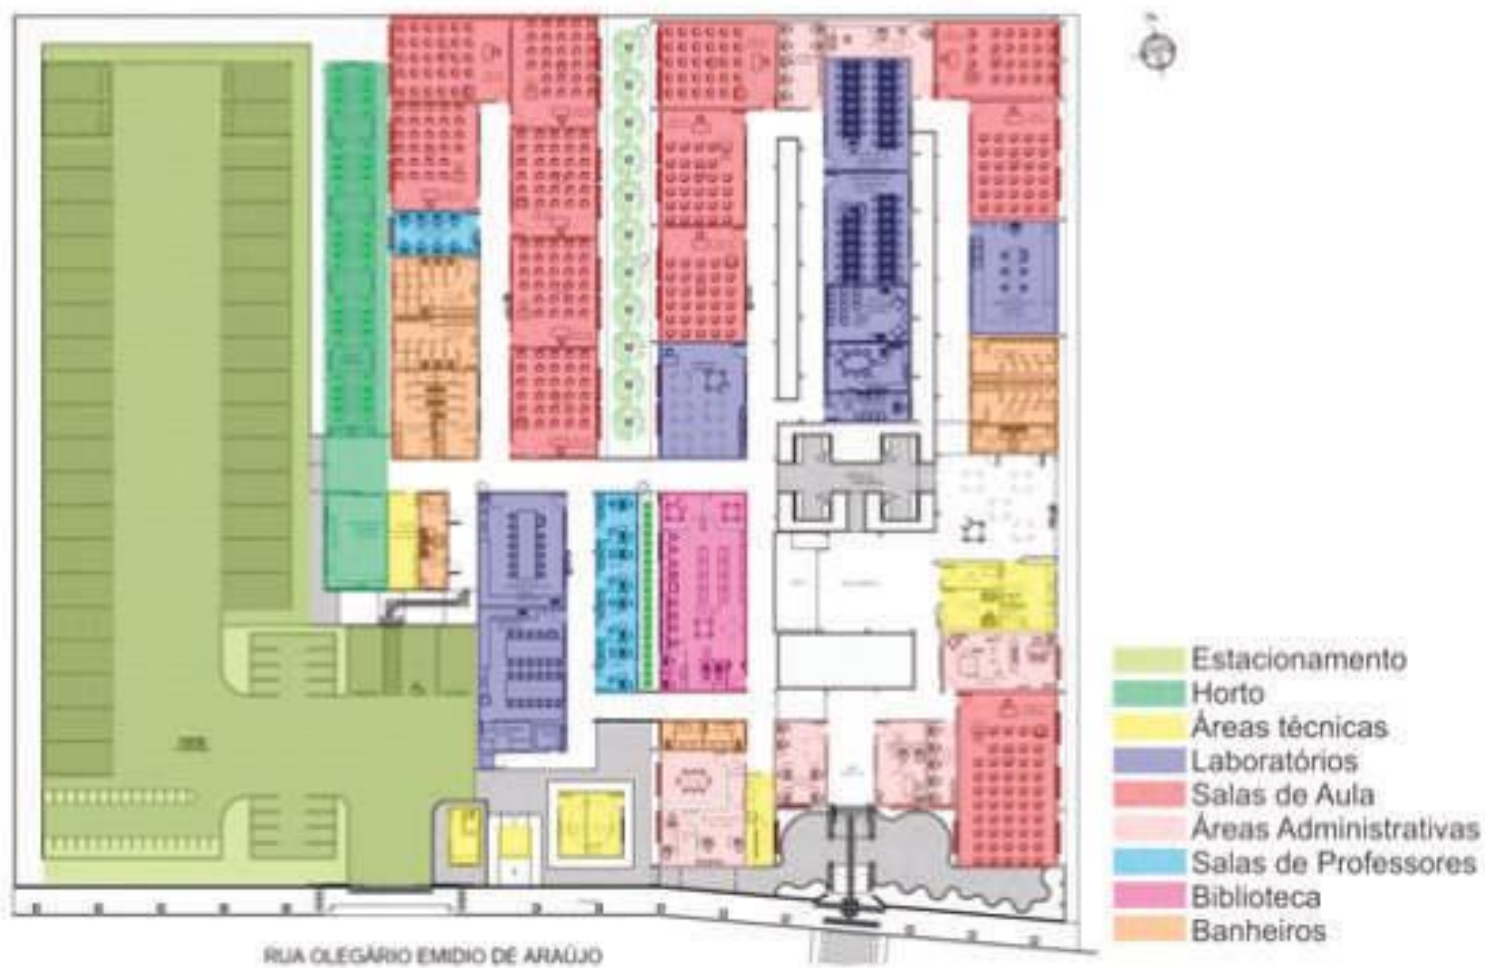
Campus Brejo Santo - Planta Baixa do Projeto de Reforma
